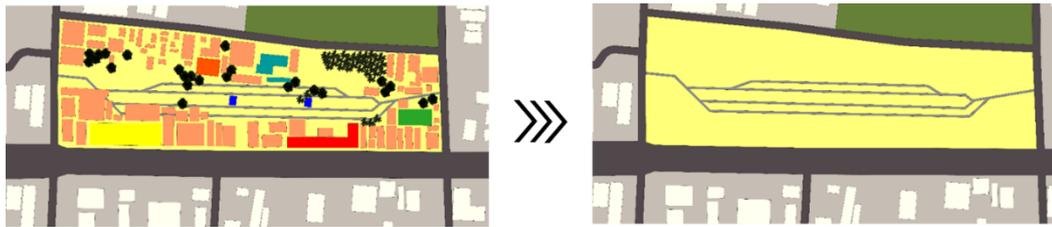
Bangunan-Bangunan Utama di Stasiun Ponorogo (Sumber: Penulis)
